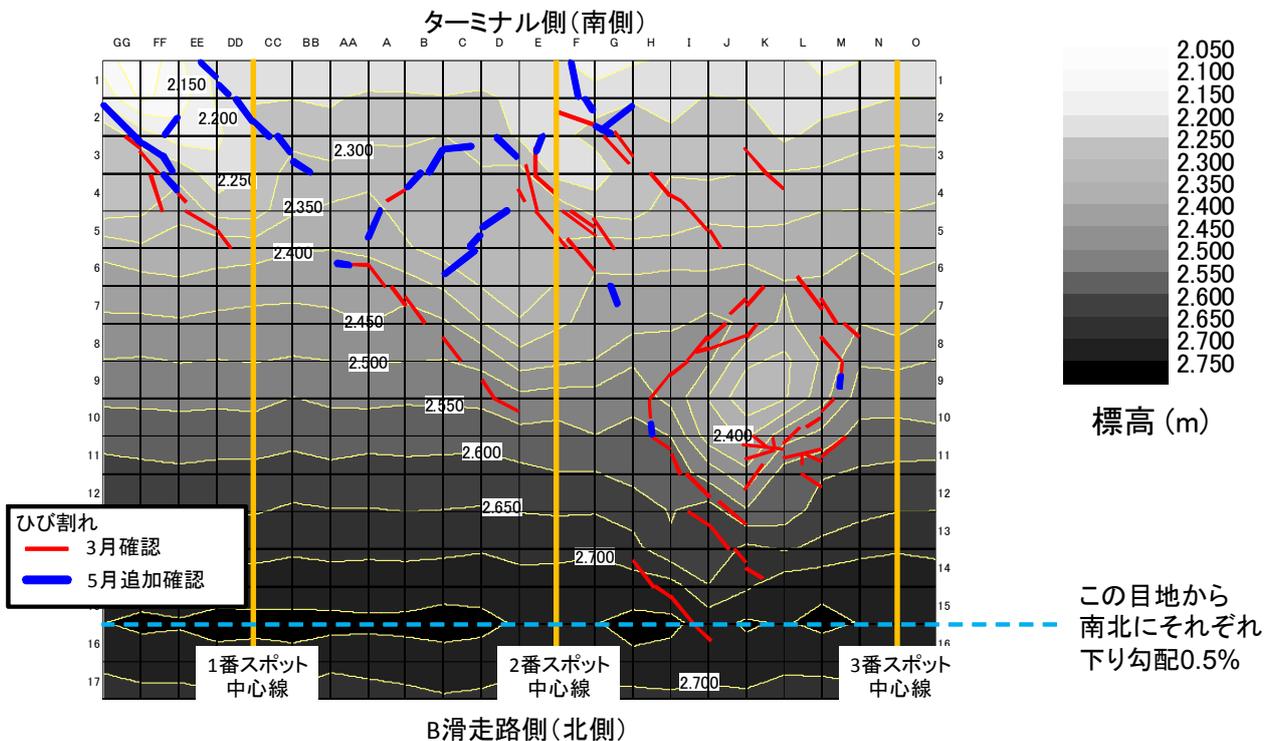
エプロンのひび割れと高さ（升目は一枚のコンクリート版（7.5m×7.5m）を示す）
